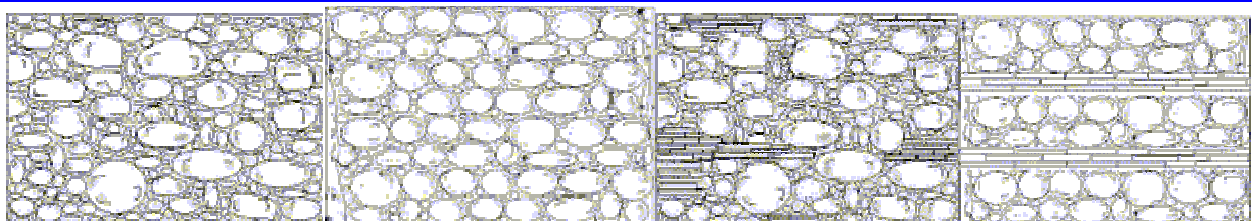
Esempi di murature in pietra arrotondata senza e con ricorsi di mattoni
